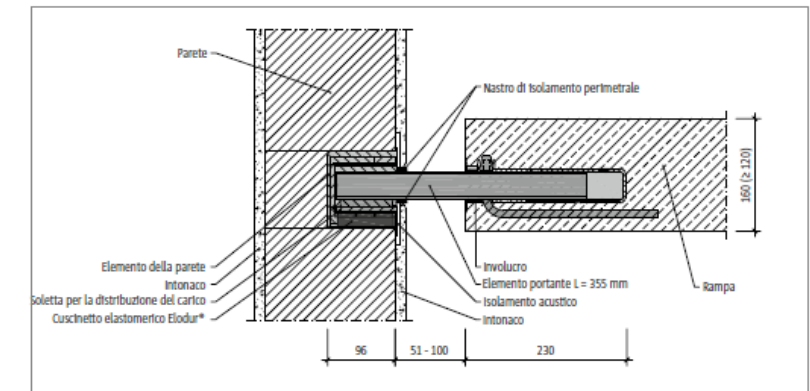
Schöck Tronsole® tipo Q-FV-XL o Q-A2-XL, sezione costruttiva
